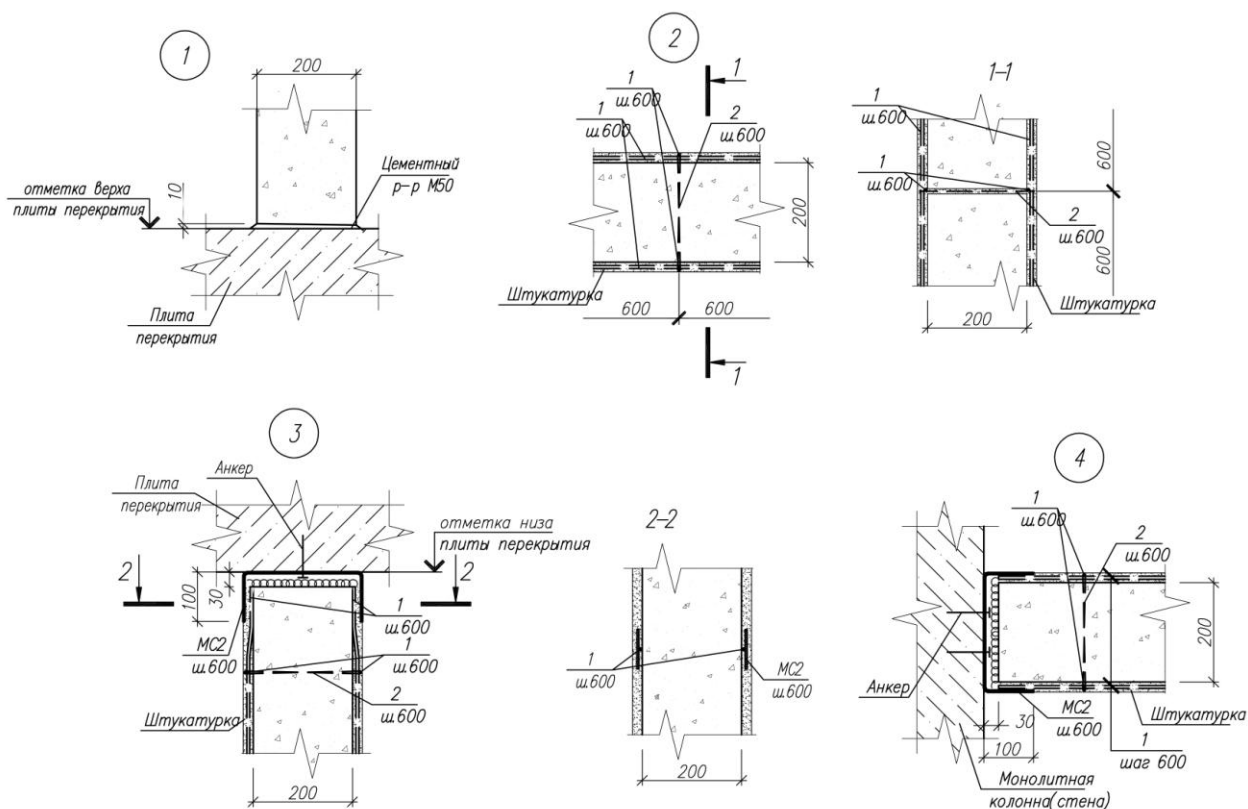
Узлы перегородок из керамзитобетонного блока толщиной 200мм
